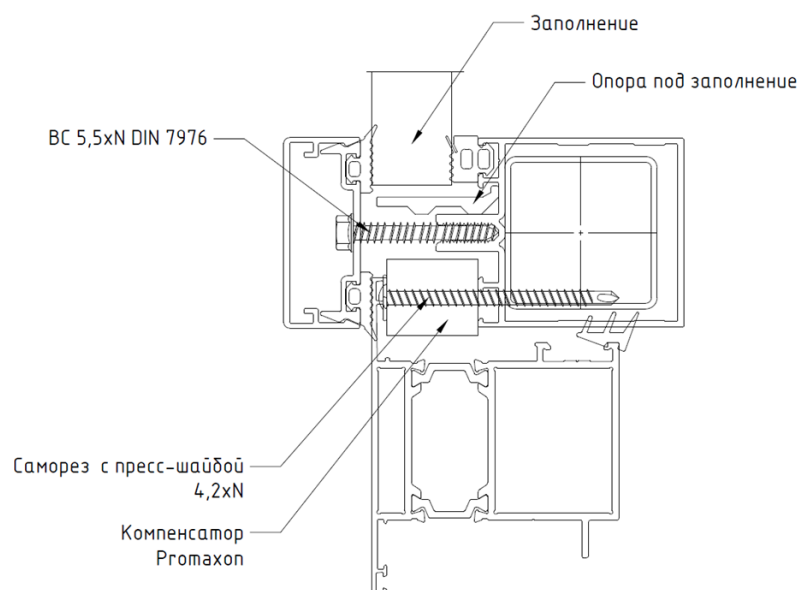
Сборка конструкции противопожарного витража при наличии двери или окна
